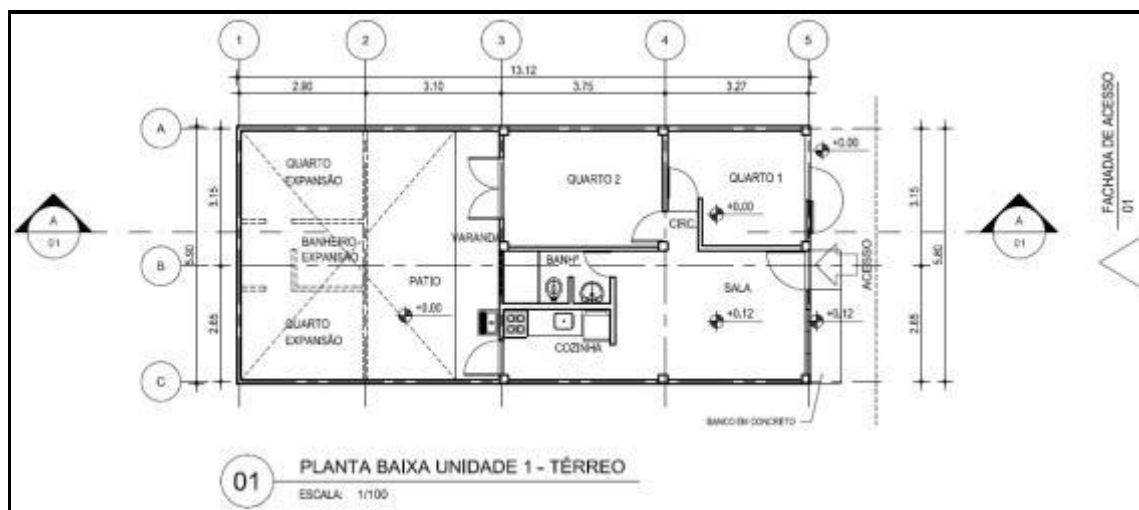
Planta da unidade habitacional 1 de Tipo A. 2007 Fonte: Licitação de Obras, planta man-arq-url-01 tipo a.pdf
